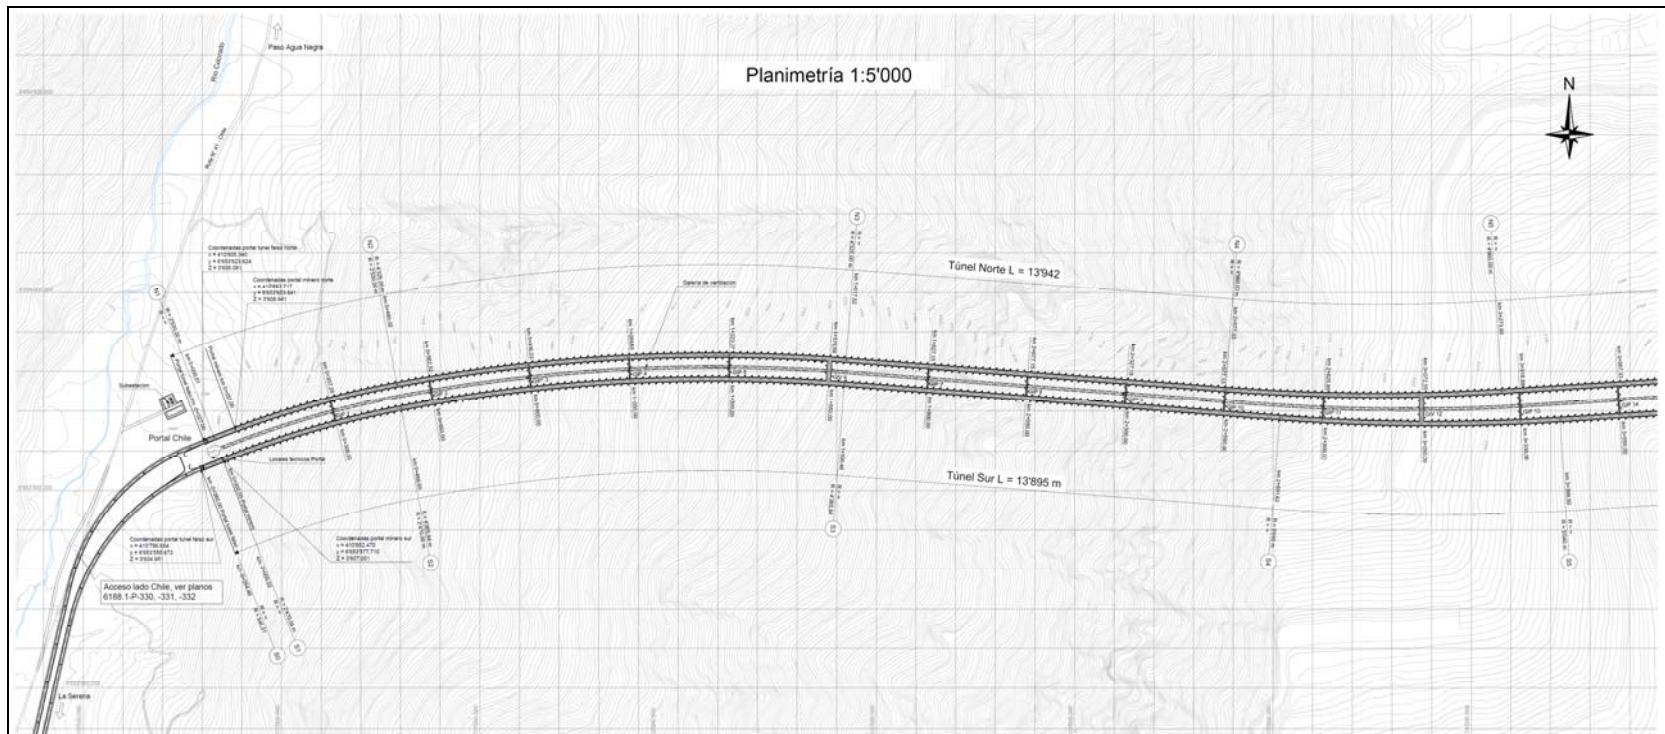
a. Planimetría parcial de la obra, gráfico 1 de 4
